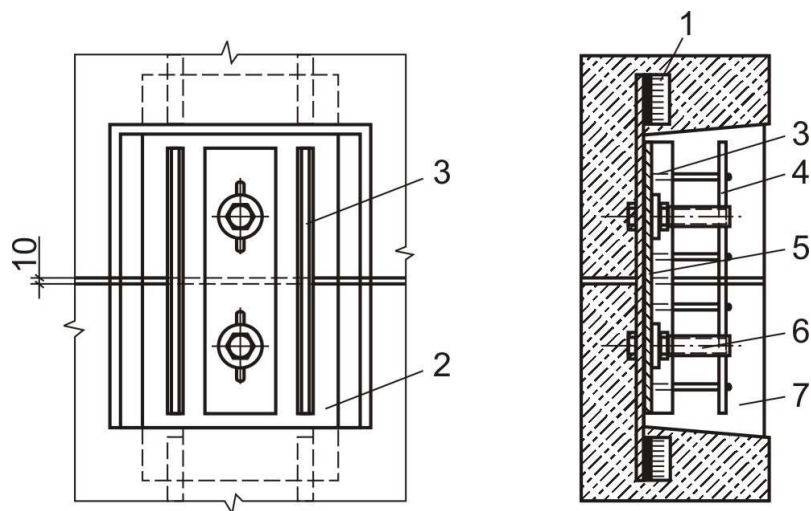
Деталь стику повздовжньої арматури труб із збірних залізобетонних царг
